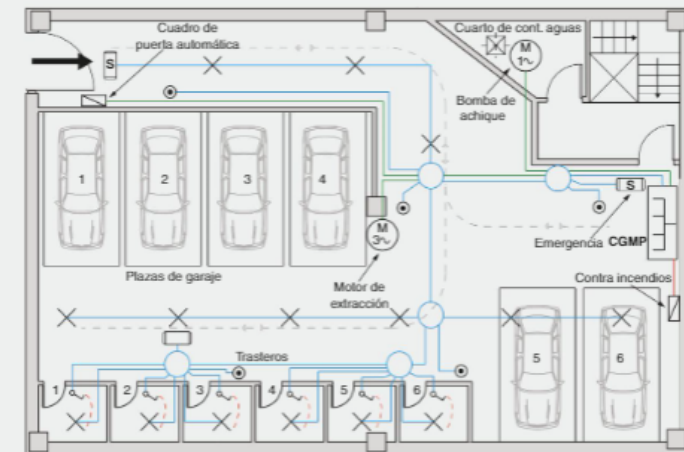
Esquema de distribución en planta de la instalación eléctrica.
